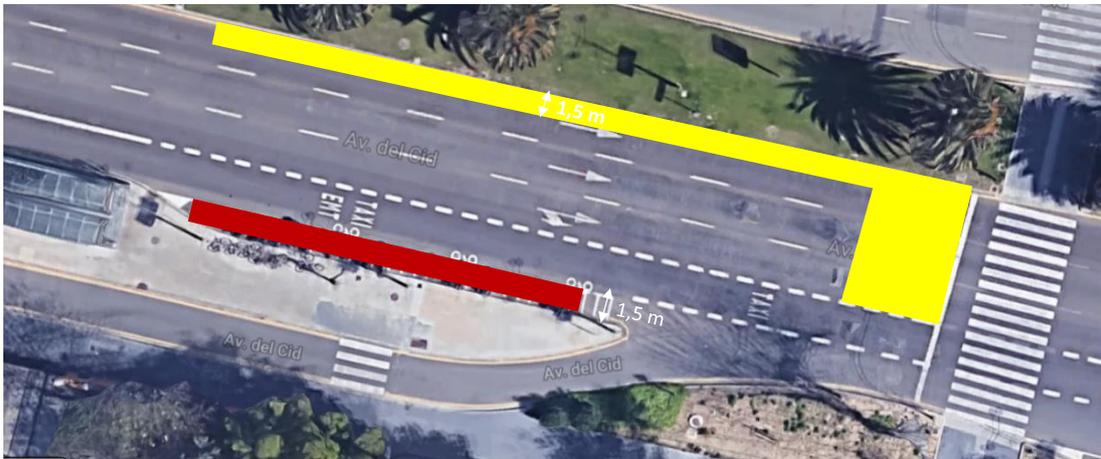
Propuesta 2 ZAM. Escenario 1. Proyecto
